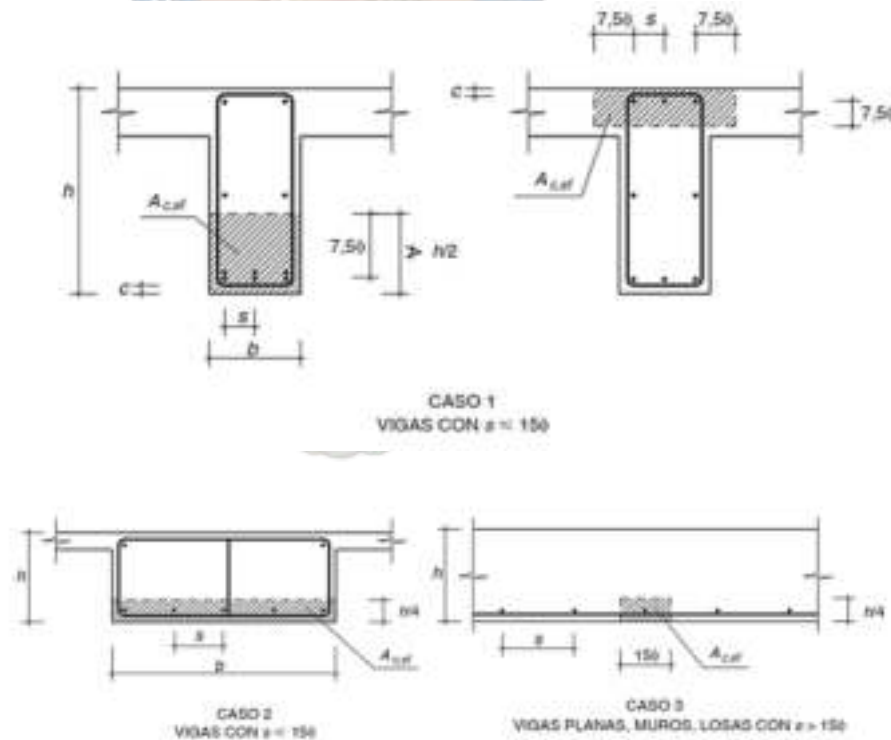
Área eficaz de hormigón que influye en el ancho de fisura
